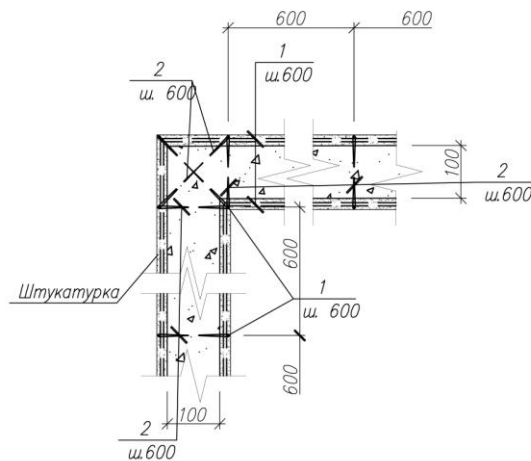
Угловое сопряжение перегородок из керамзитобетонных блоков толщиной 100мм
